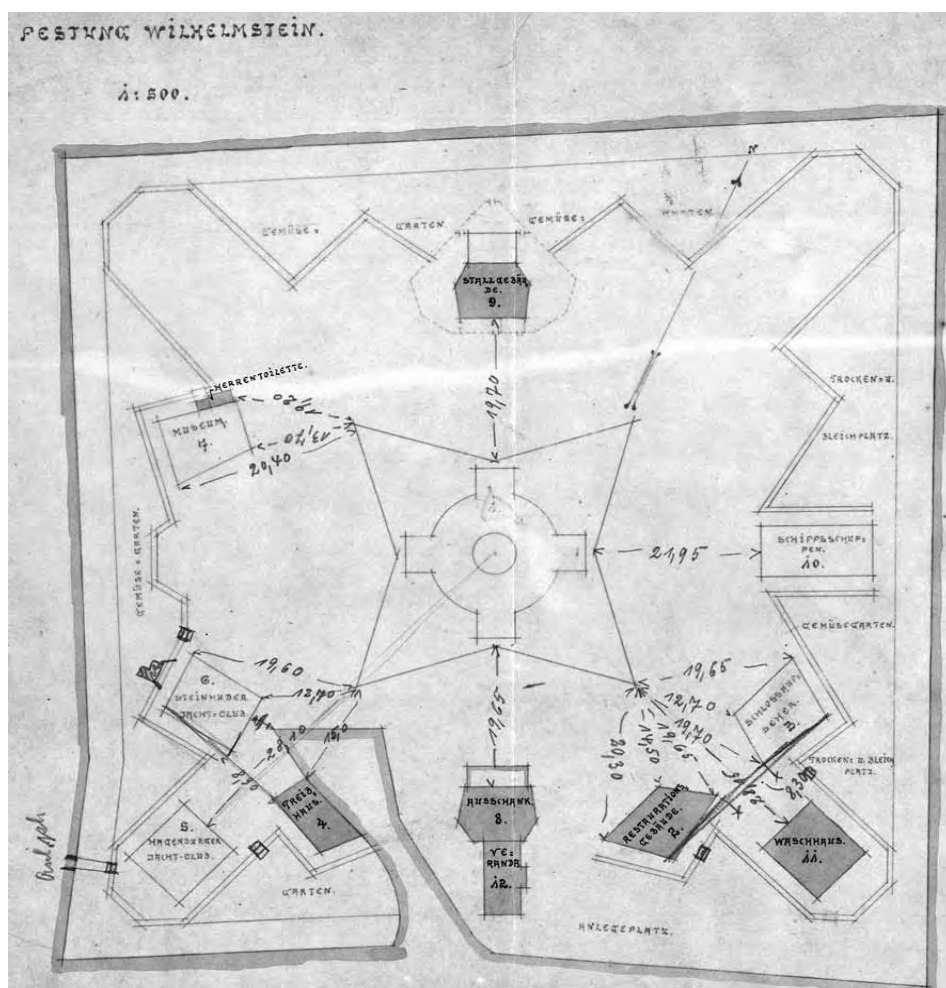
Wilhelmstein im Steinhuder Meer, Grundriss mit Gebäudebezeichnungen (NLA – StA Bückeburg S 1 B Nr. 3532 Bl. 3).
